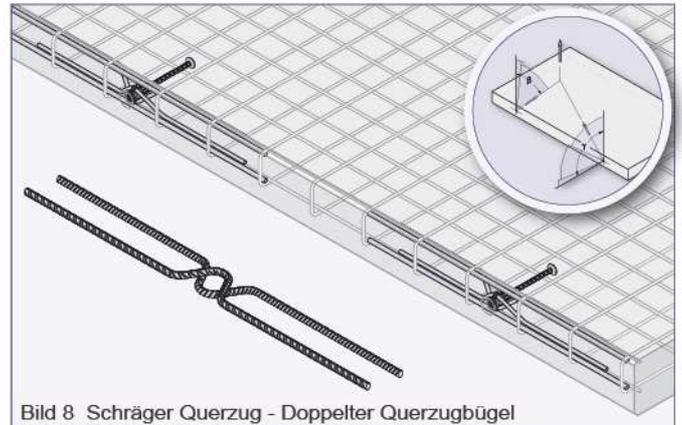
Schräger Querkzug - Doppelter Querkzugbügel
